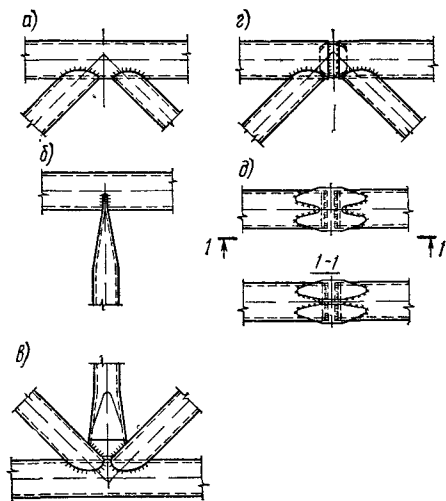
Заводские узлы и монтажные стыки стропильных ферм с элементами из круглых труб
